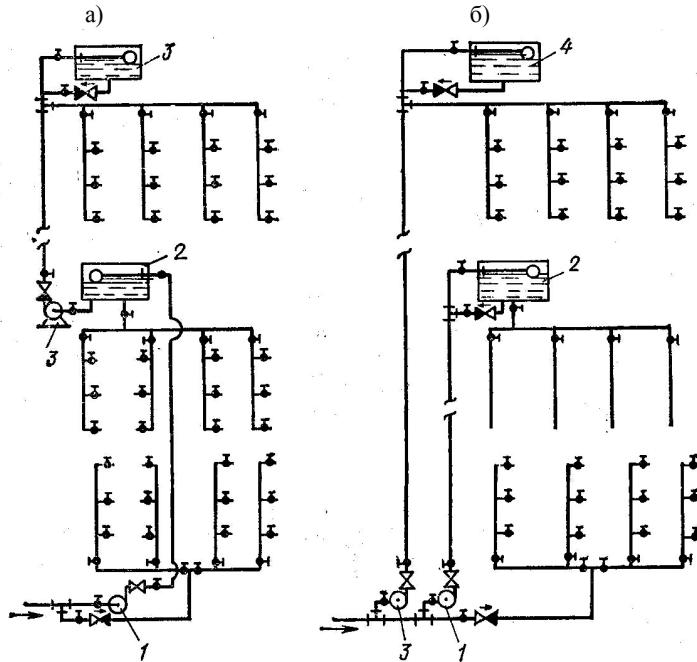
Последовательная (а) и параллельная (б) схемы зонирования водопроводов зданий:
